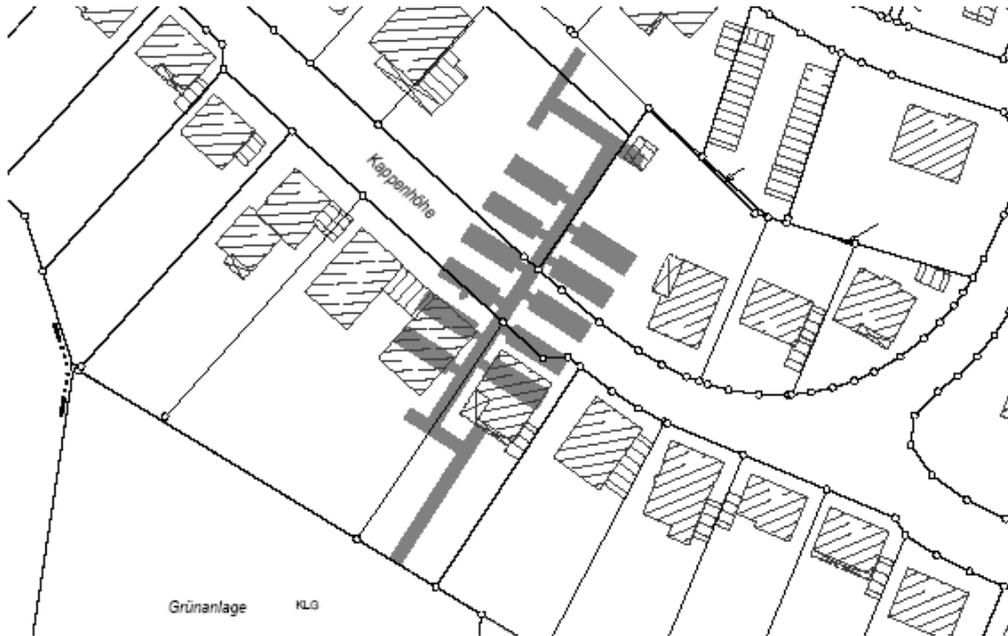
Lageplan Luftschutzstollen KAPPENHÖHE
